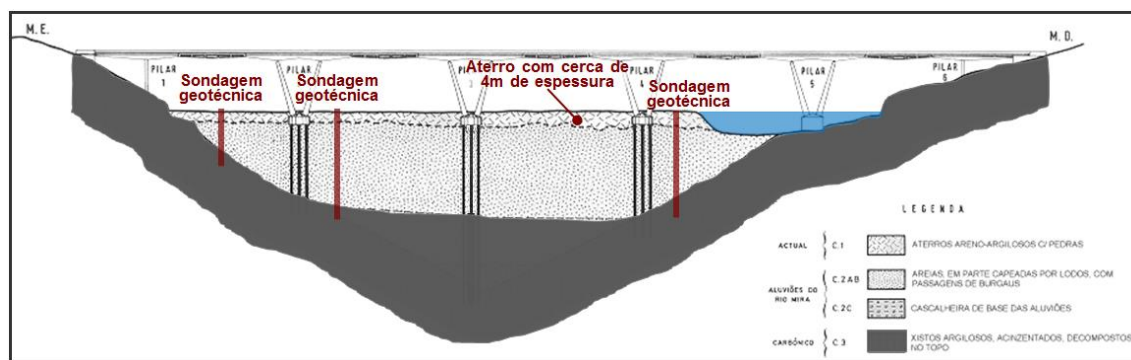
Corte longitudinal incluindo a estrutura da ponte e a península de aterro implantadas sobre o perfil geológico interpretativo
